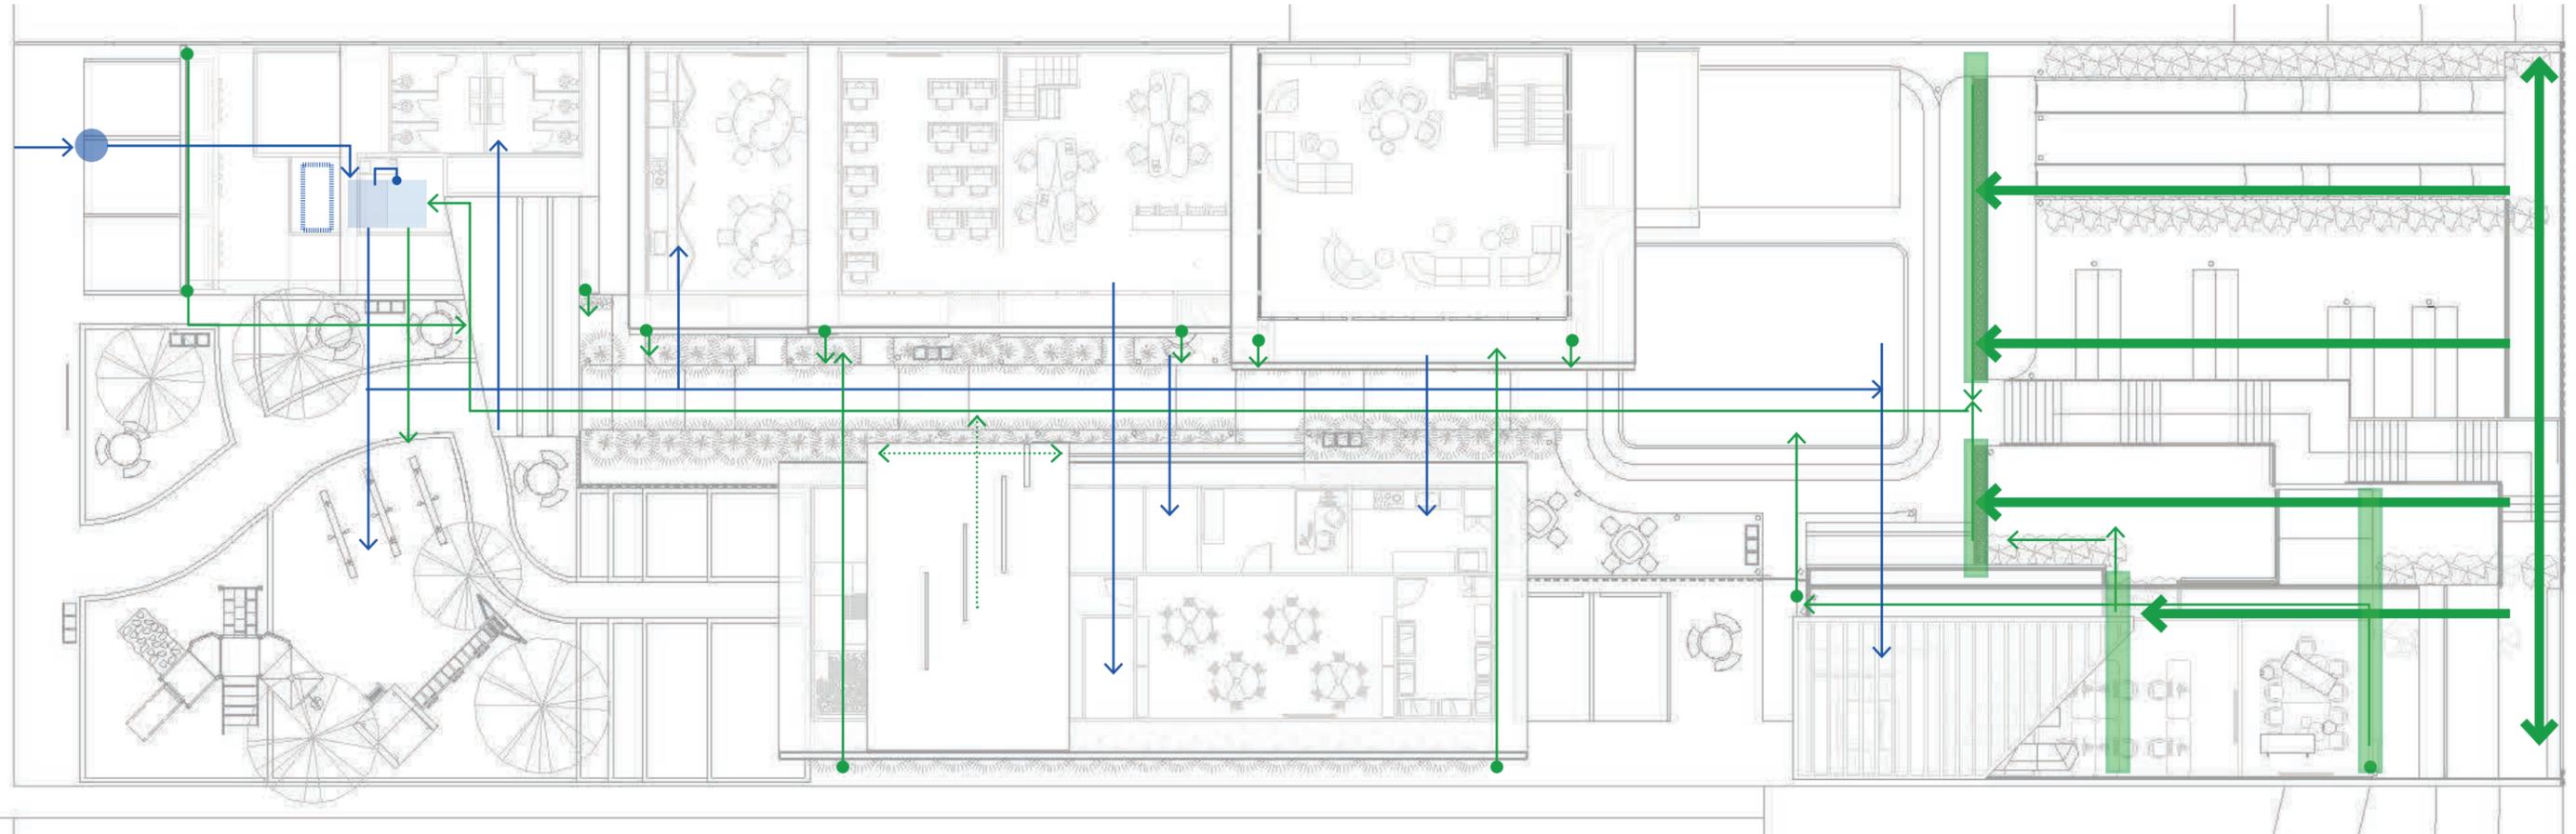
Planta rutas agua potable y llovidas. Fuente: Propia.
